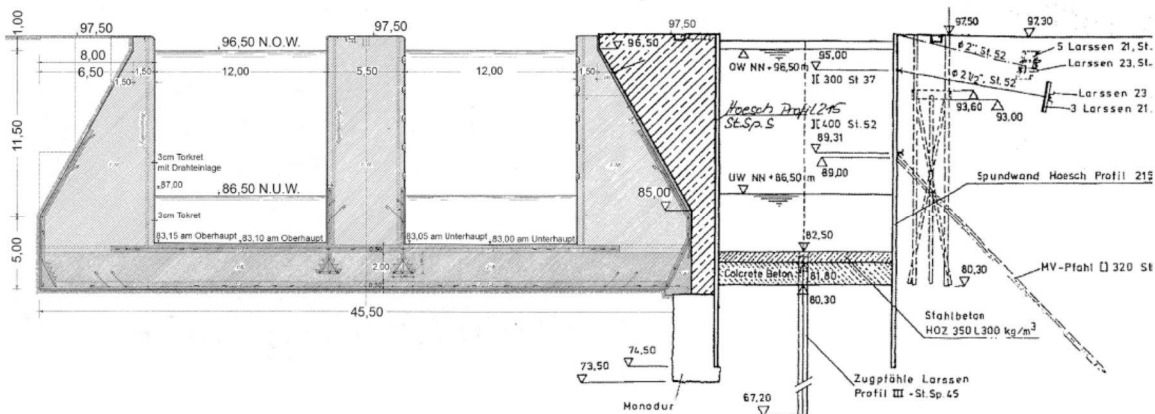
Regelschnitt Kammerbereich mit „Ersatzschleuse“
